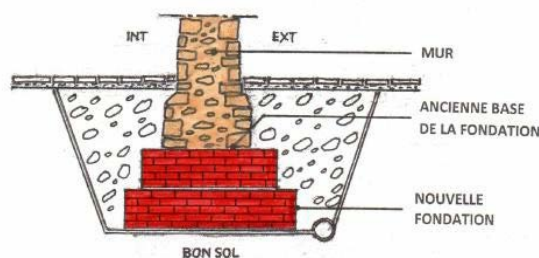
Consolidation de la fondation en sous-œuvre par maçonnerie.
